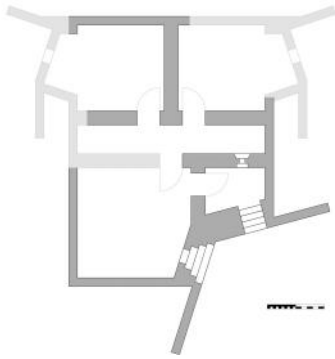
Rekonstruktion des Grundrisses nach Aufmaß.
